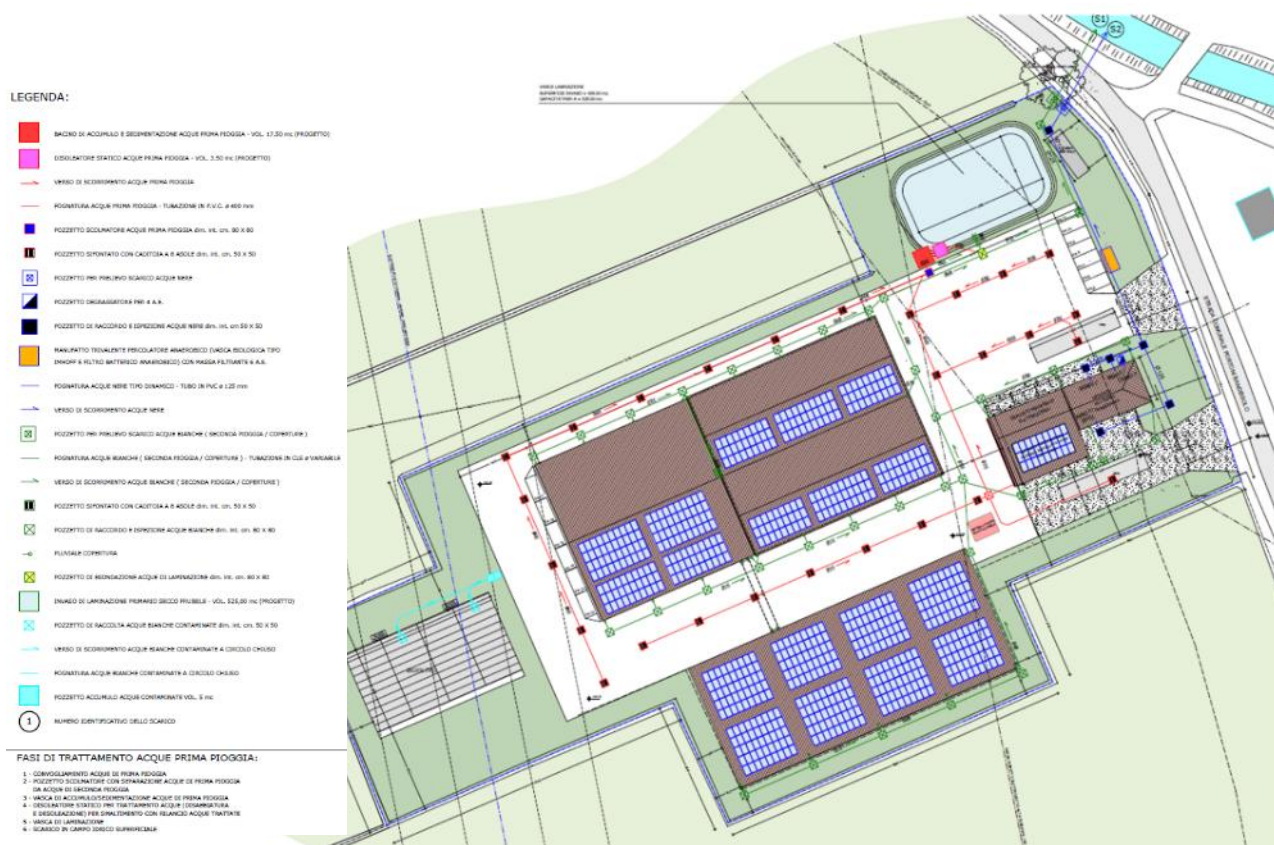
Planimetria rete raccolta e smaltimento acque (stralcio Tav. 10)
